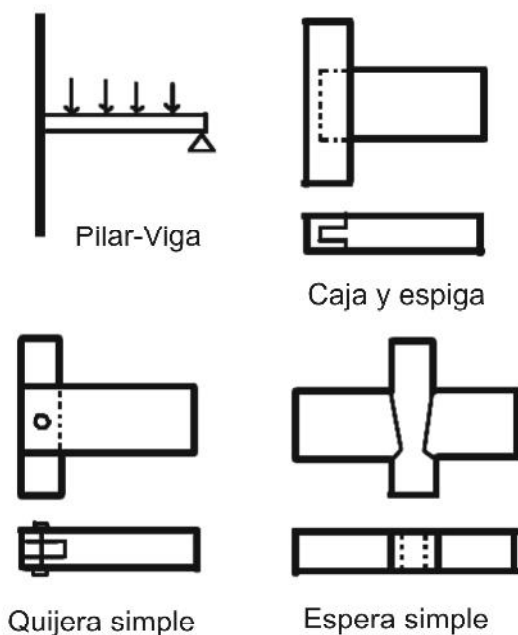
Posibles ensamble de encuentro entre columna y viga.
